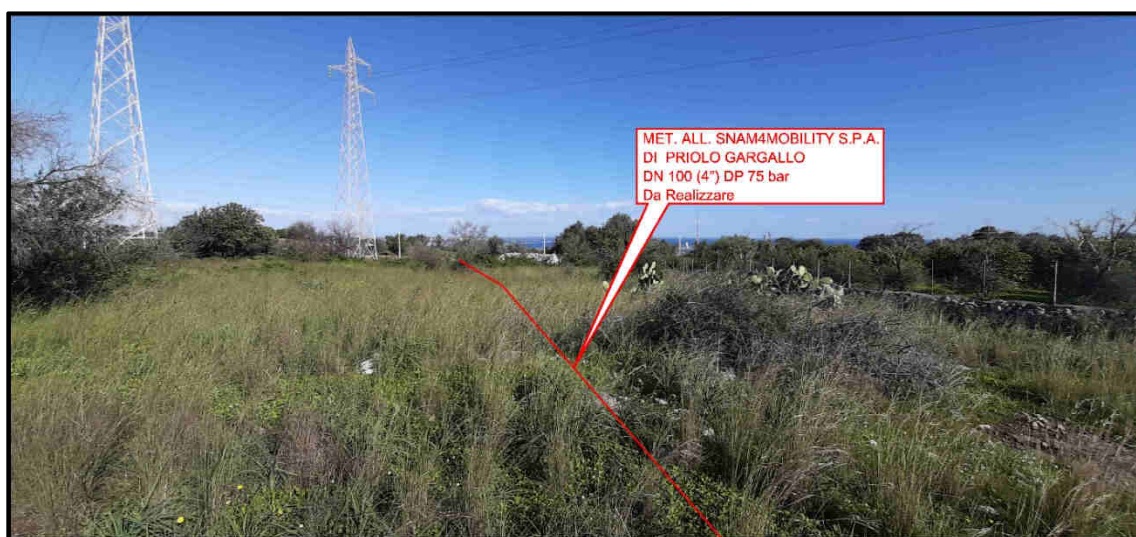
Vista Met. in progetto, percorrenza in fondo privato.
